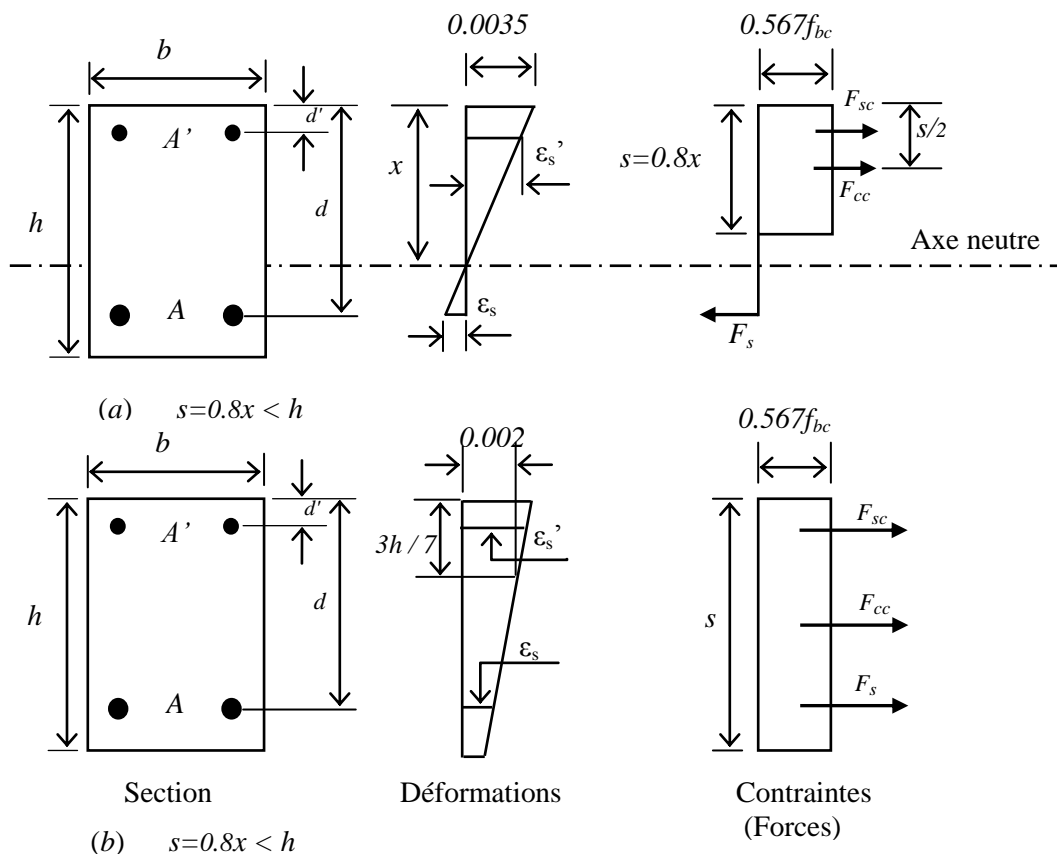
Cas de flexion composée dans la section transversale du poteau [27]
